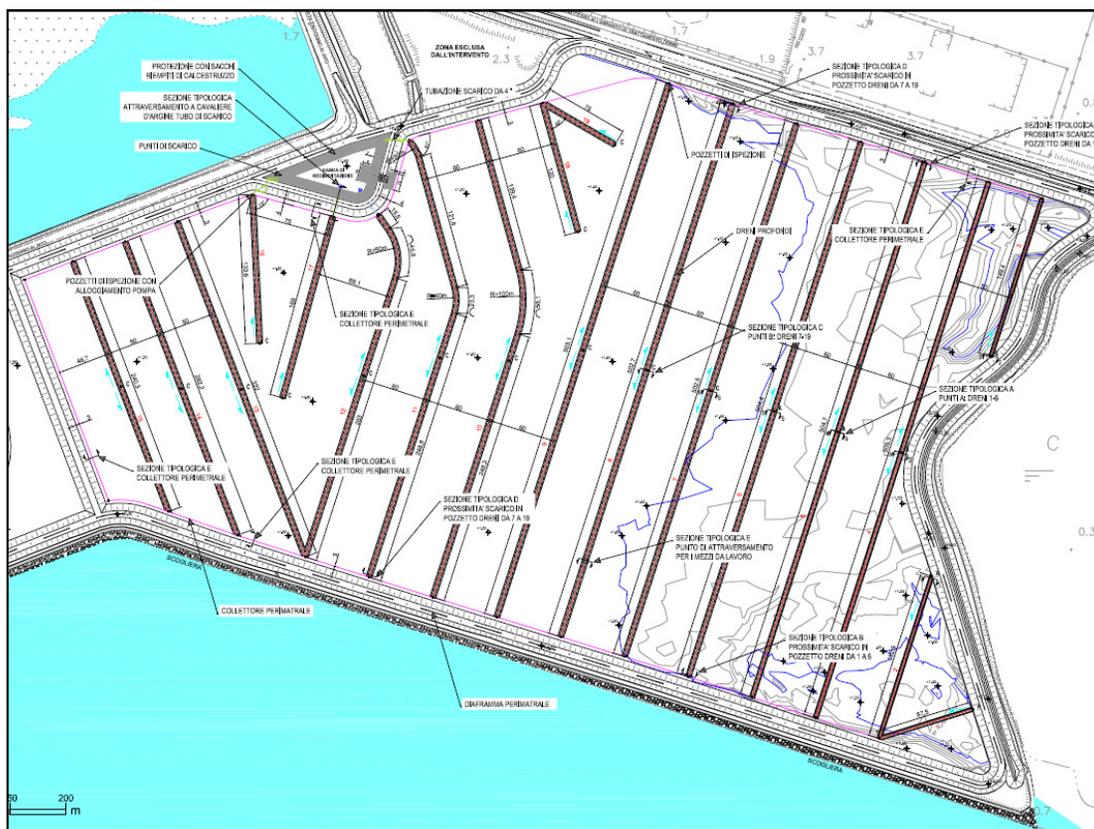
Planimetria della rete di drenaggio profondo
